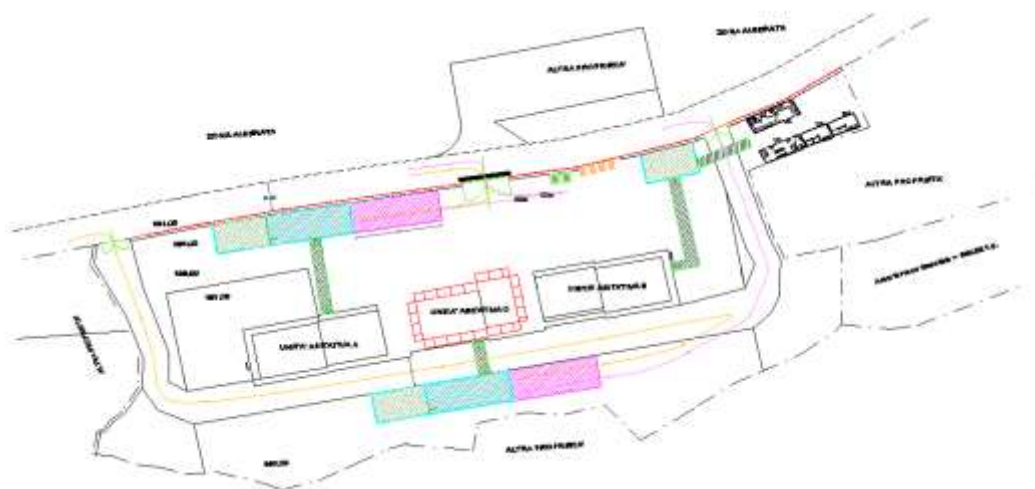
Stralcio del layout di cantiere con allestimento dei ponteggi
